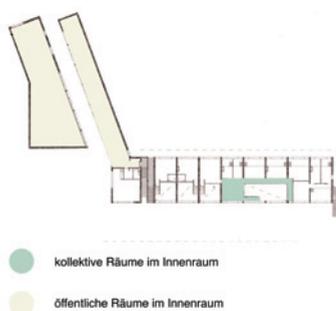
Grundriss Sargfabrik, Anteil an öffentlichen und kollektiven Räume
